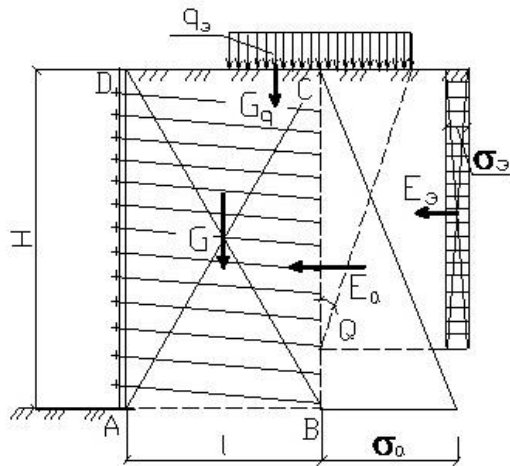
Расчетная схема к определению устойчивости армированного нагелями массива
